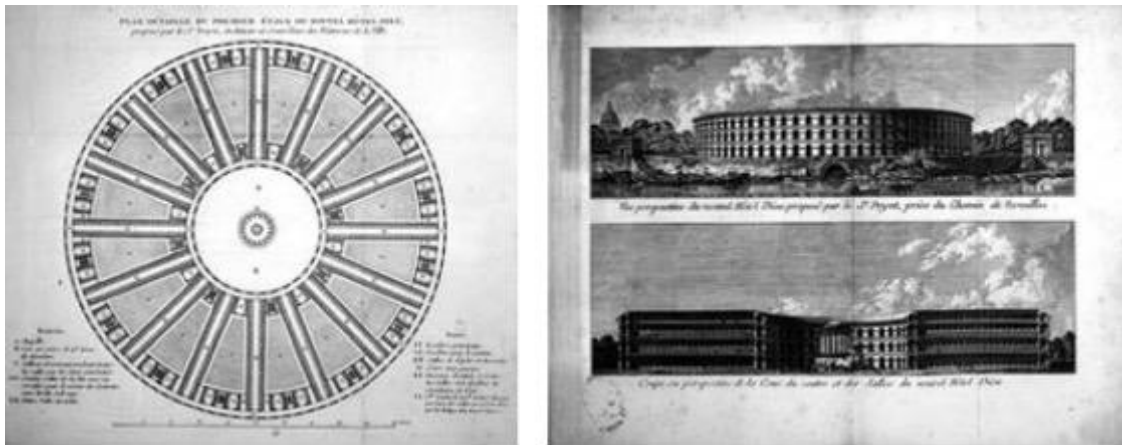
Hospital radial diseñado por Coquéau y Poyet, planta y alzado y corte. Fuente: (JORI, 2009a)
